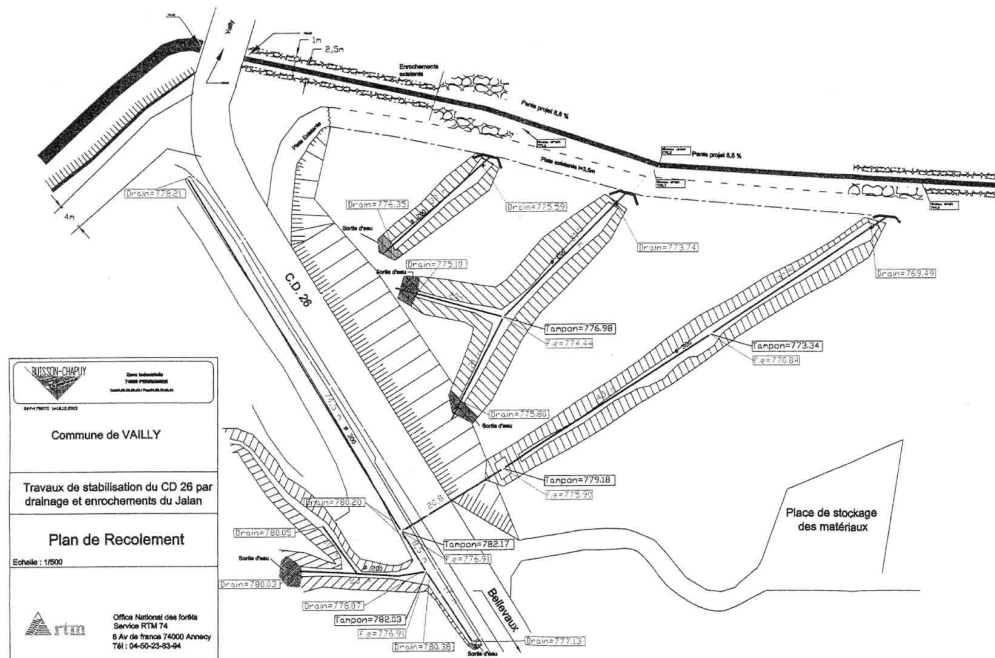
Plan de récolement d'un système de drainage par tranchées drainantes (document RTM-74).
